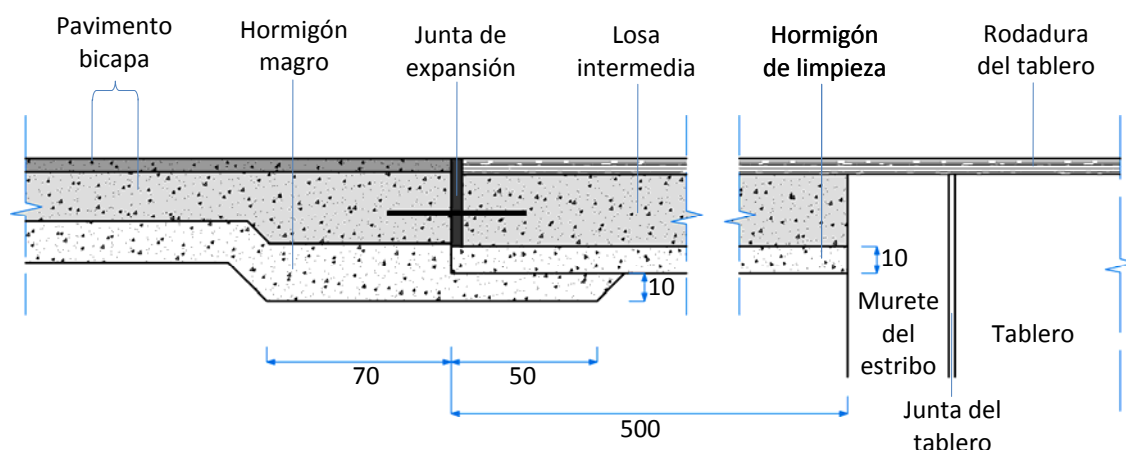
Transición de un pavimento bicapa y un puente (losa intermedia contigua)
